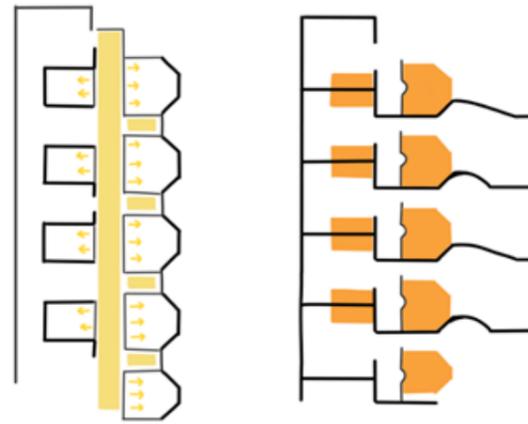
Entrada de luz por la pasarela superior y los dormitorios (planta primera). La luz llega hasta las cocinas (planta baja). Elaboración propia.
